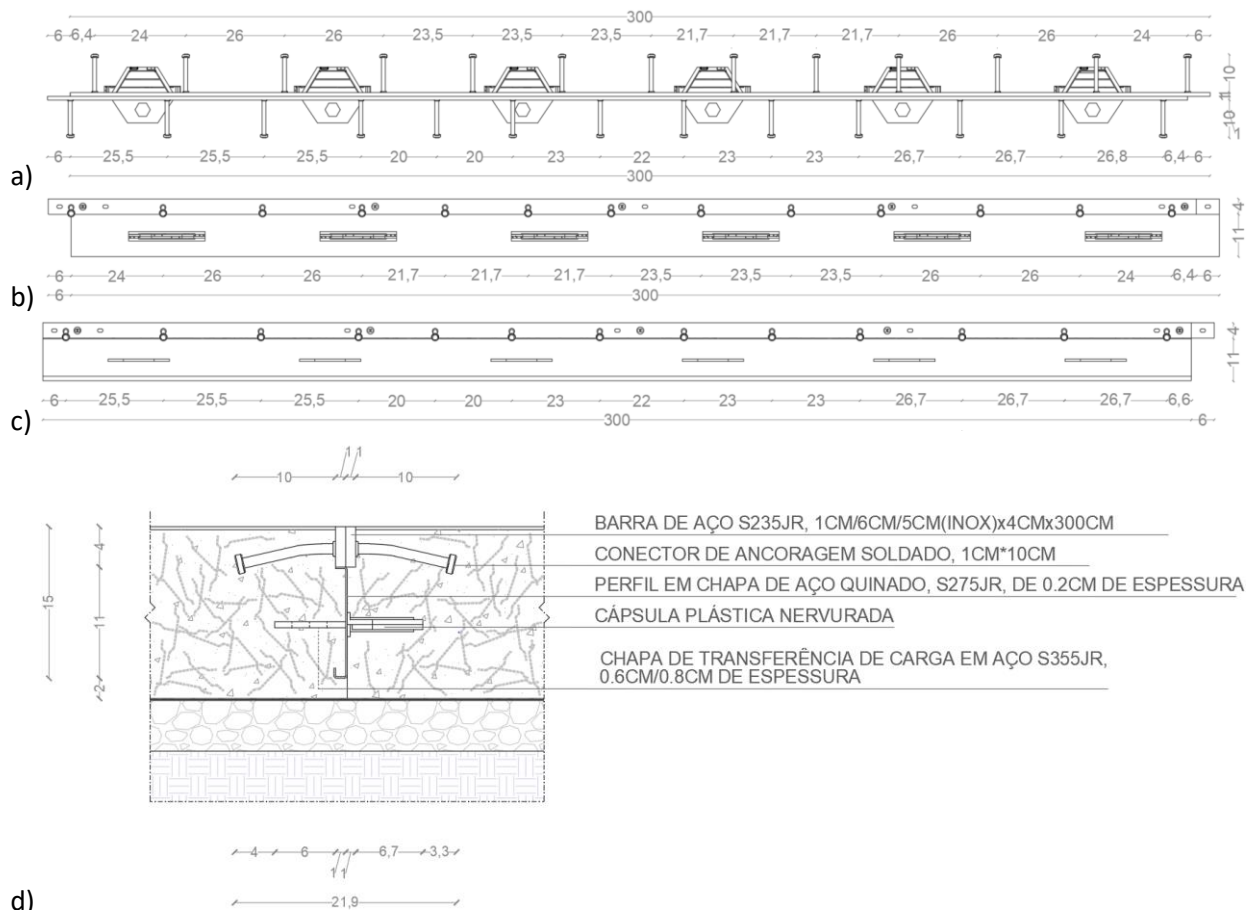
Desenhos de pormenor da StrongJoint Two Wave: a) Vista superior; b) Vista lateral direita; c) Vista do lado esquerdo; d) Corte transversal
